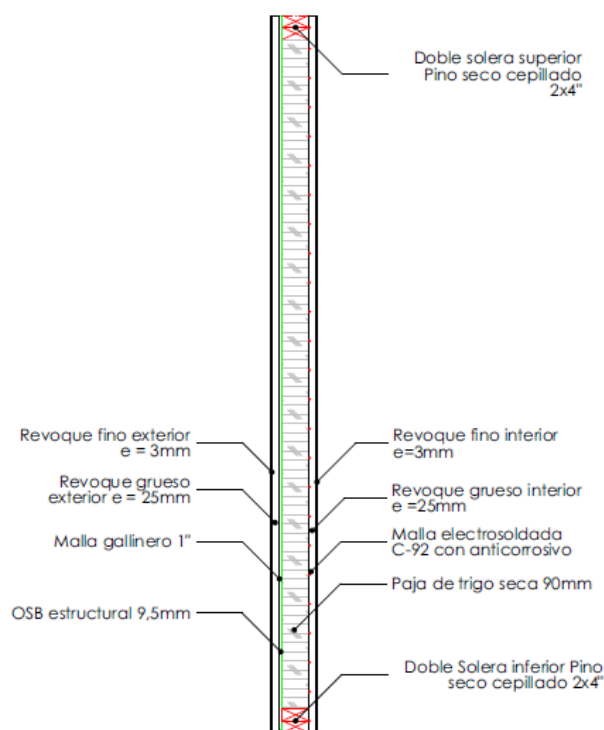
Detalle constructivo Muro Constructora AYMA Ltda.
